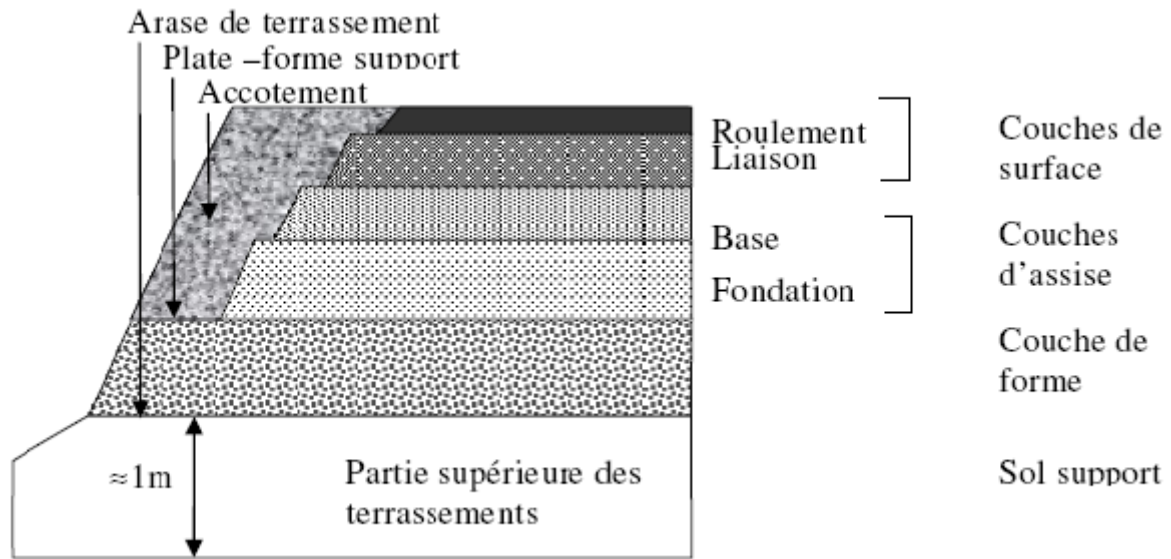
Coupe verticale d'un corps de chaussée type.
